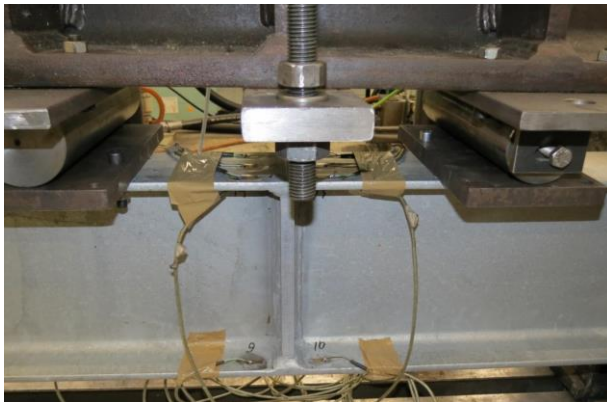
Detail des Versuchsaufbaus Walzprofil mit Quersteife [116]
